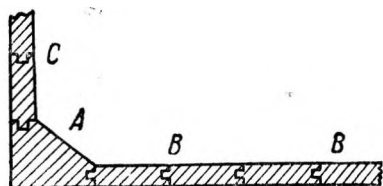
Выстилка понурного и сливного полов. *A* — четвертина с двумя шпунтами; *B* — пол; *C* — боковая обшивка.
